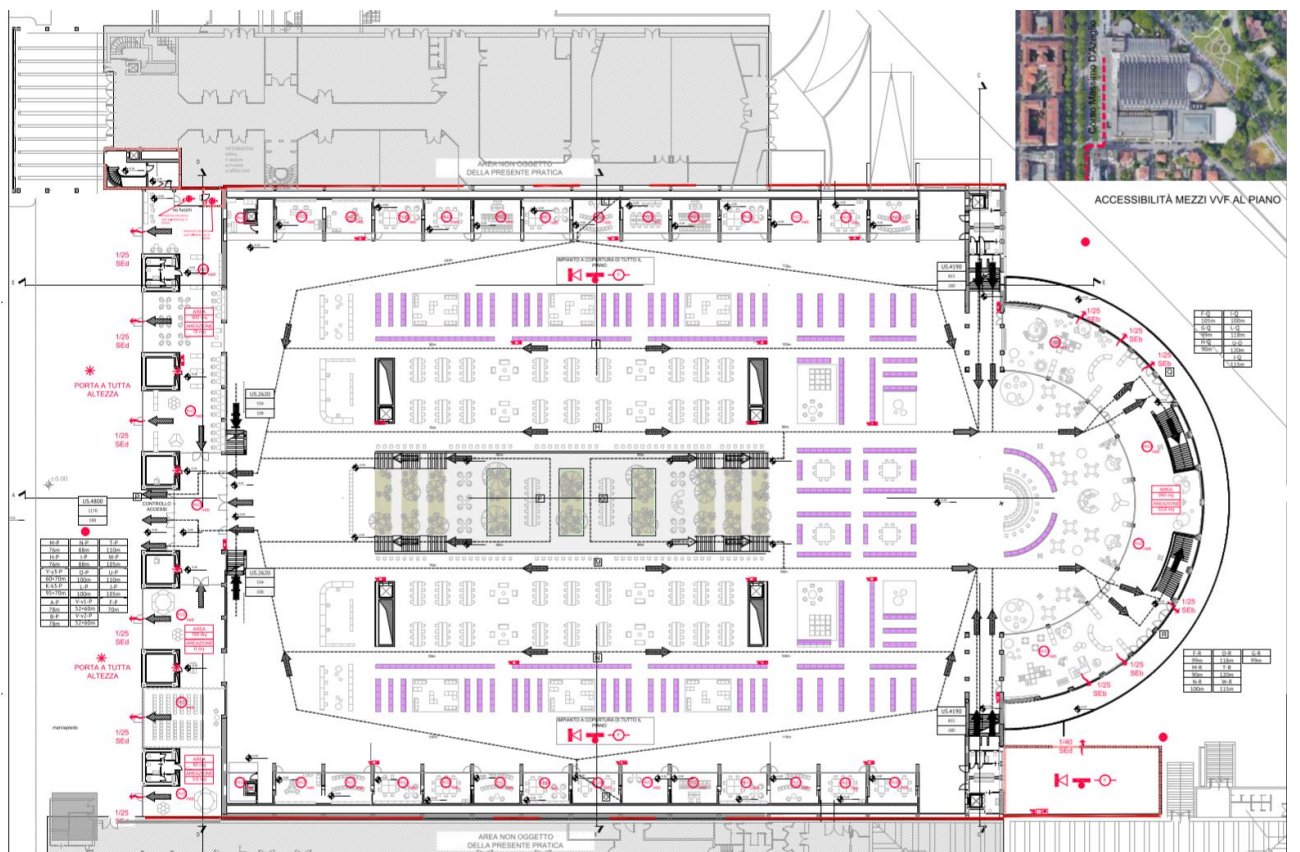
Progetto di prevenzione incendi - Pianta Piano Terra
